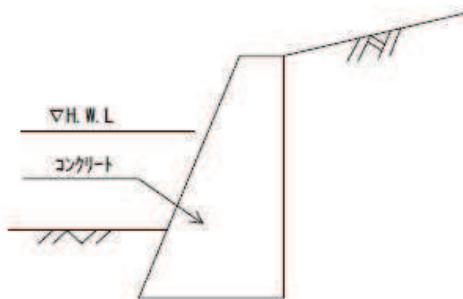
自立式護岸の例（コンクリート擁壁工）
